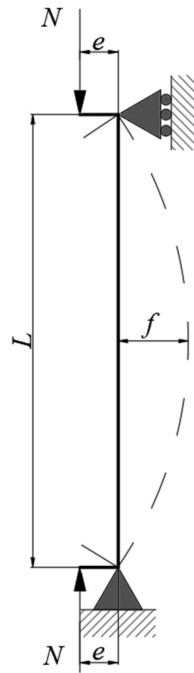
Схема загрузки трубобетонного стержня
